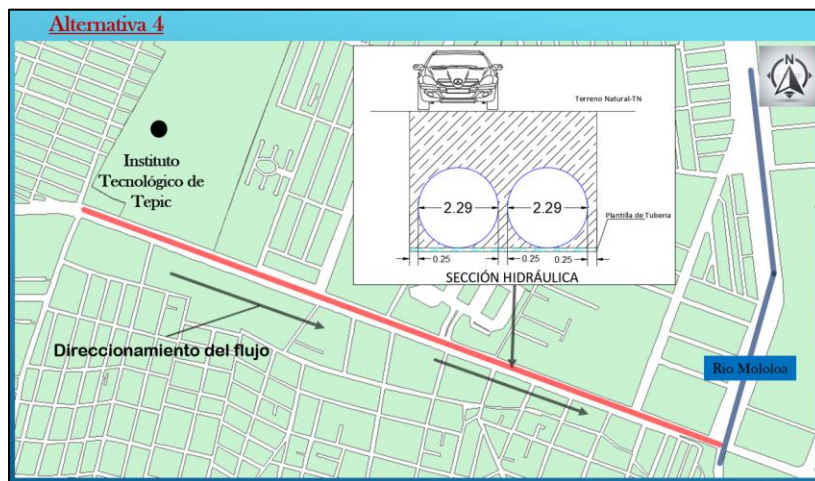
Resumen de red de distribución en planta y secciones hidráulicas de alternativa 4.
